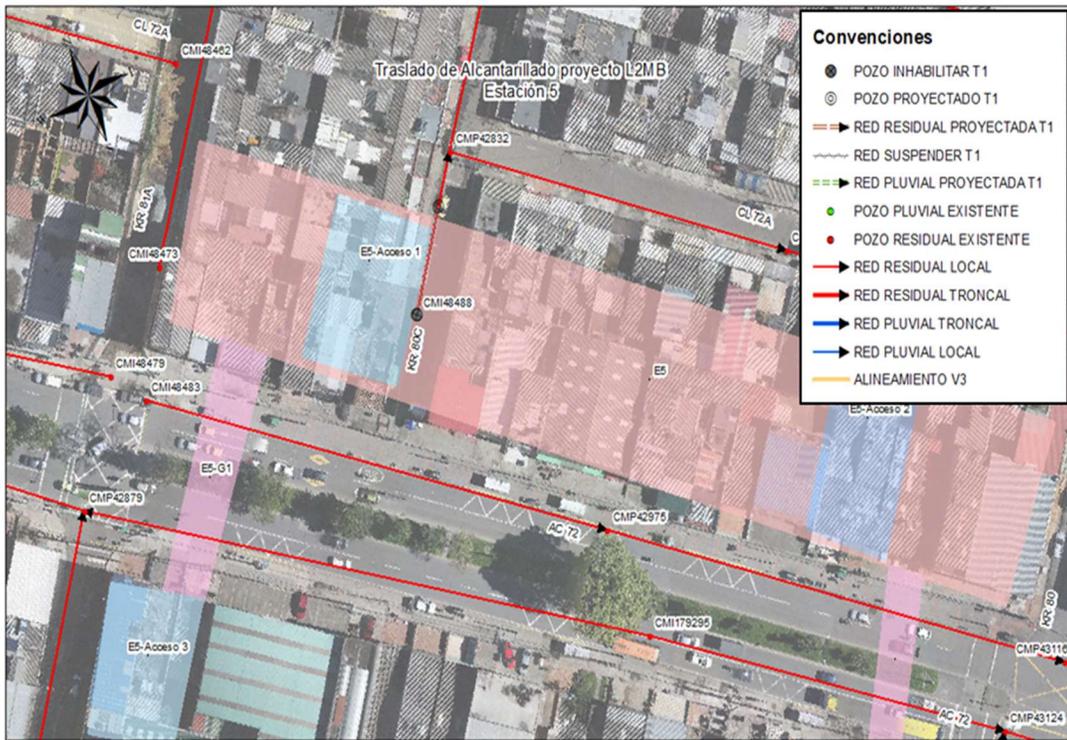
Traslado redes de alcantarillado Estación 5 Calle 72 con Carrera 80C
